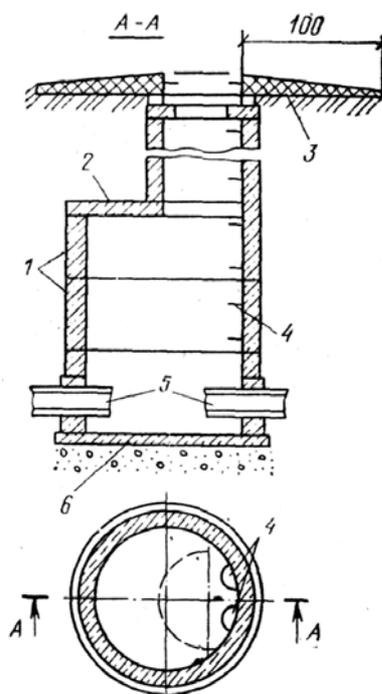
Водопроводный колодец: 1 – кольцо из железобетона; 2 – плита перекрытия; 3 –отмостка; 4 – скобы; 5 – трубы водопроводной сети; 6 – днище
